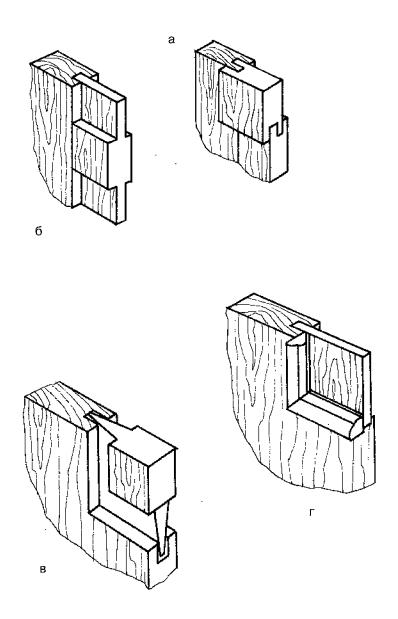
Филенки деревянной двери: а — наплавная; б — плоская; в — с фигареями; г — с окладными калевками
